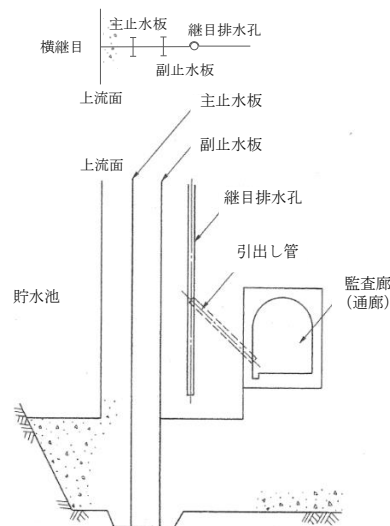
継目排水孔の構造(上: 平面、下: 断面)⁷⁾
